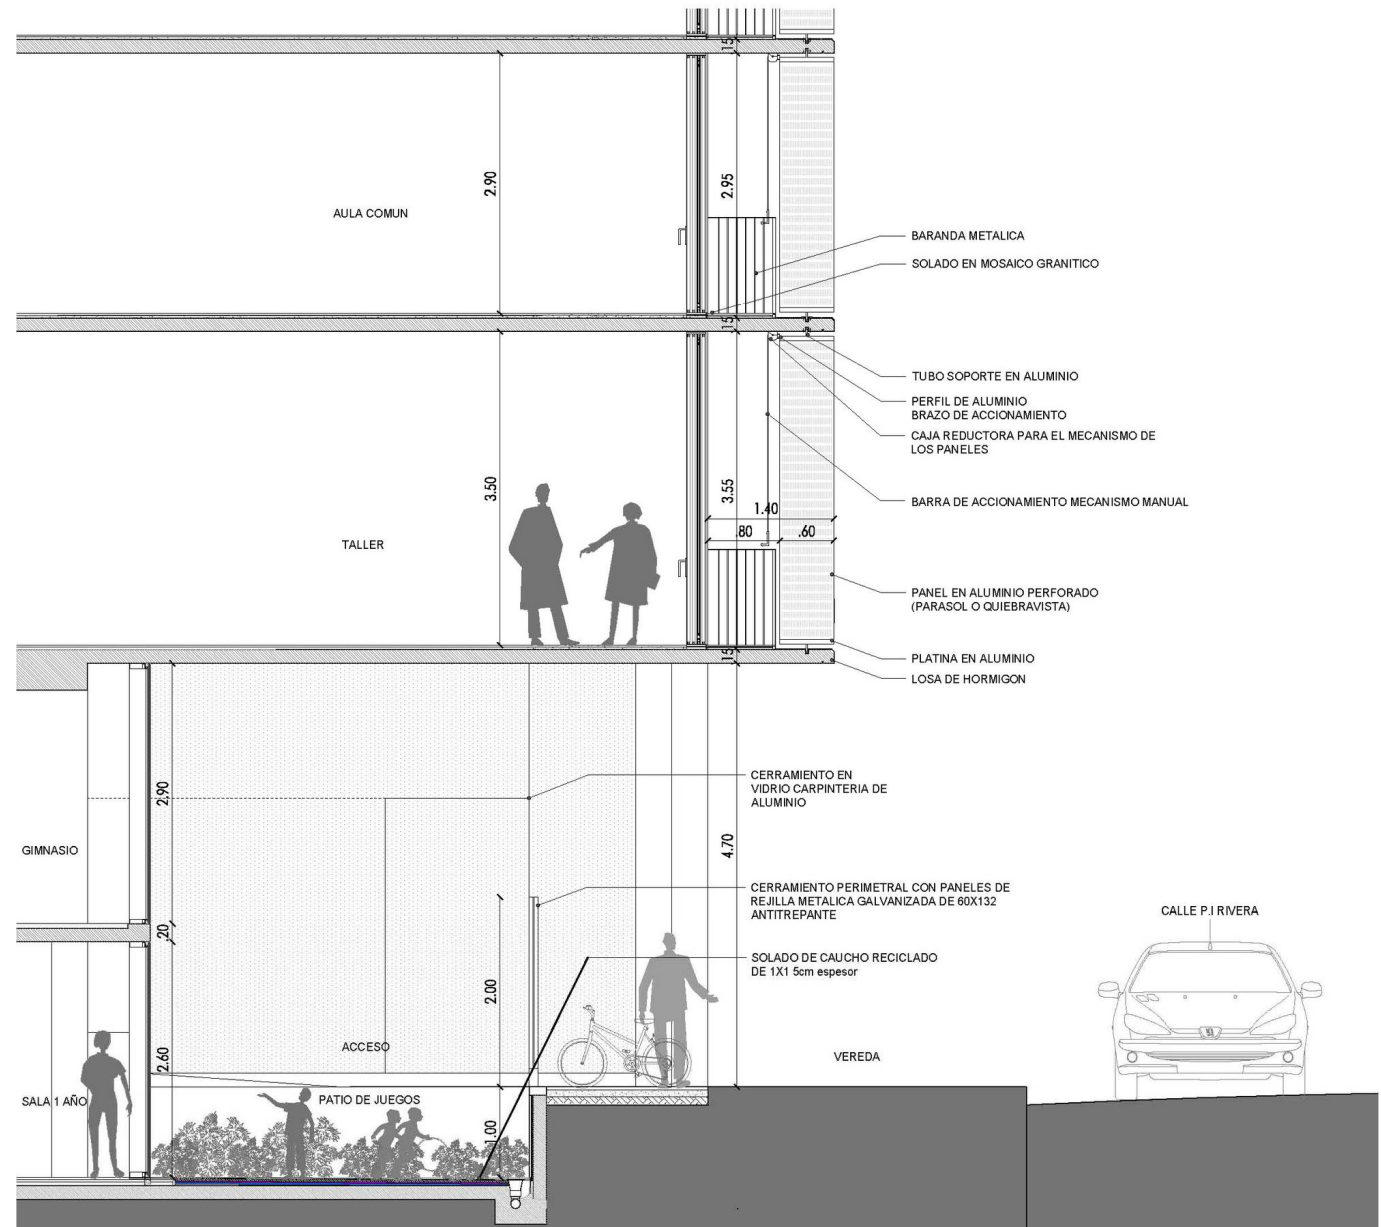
Detalle Corte fachada ISPEE (Frente Calle Rivera)
